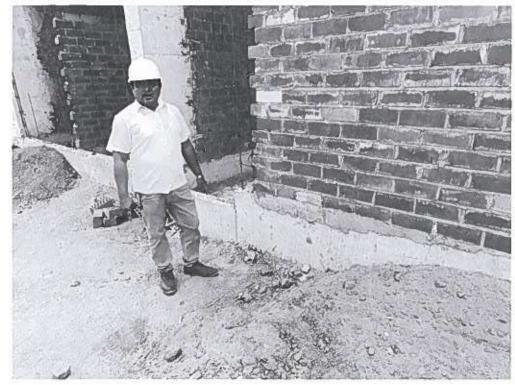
Se visualiza el empastado entre el muro exterior y sobrecimiento del bloque N.º 15.
